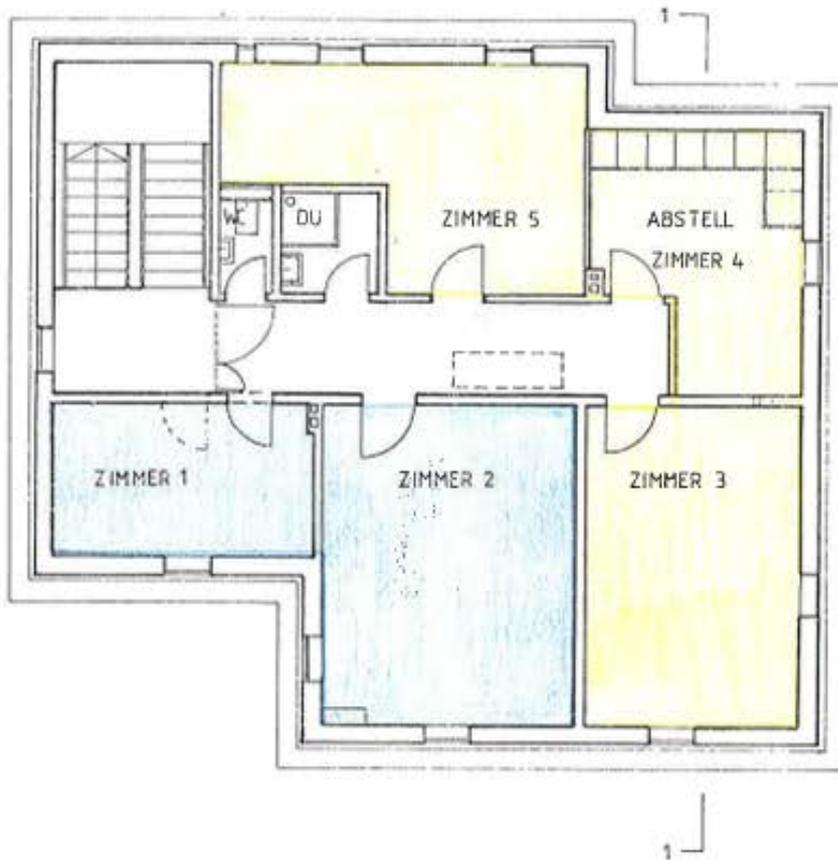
Grundriss Dachgeschoss Lettenstrasse 3, 8408 Winterthur
